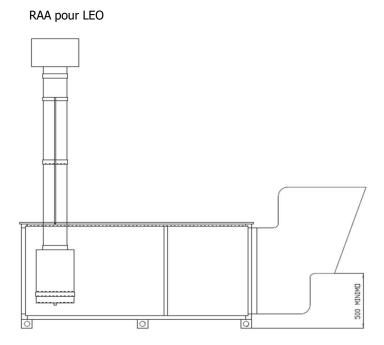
Distances minimum d'installation du générateur des parois et du plafond, pour entretien
